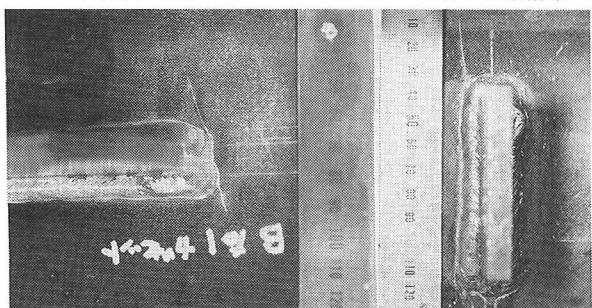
ウエブガセット廻し溶接部の疲労亀裂 写真-4 垂直スティフナー部の疲労亀裂
